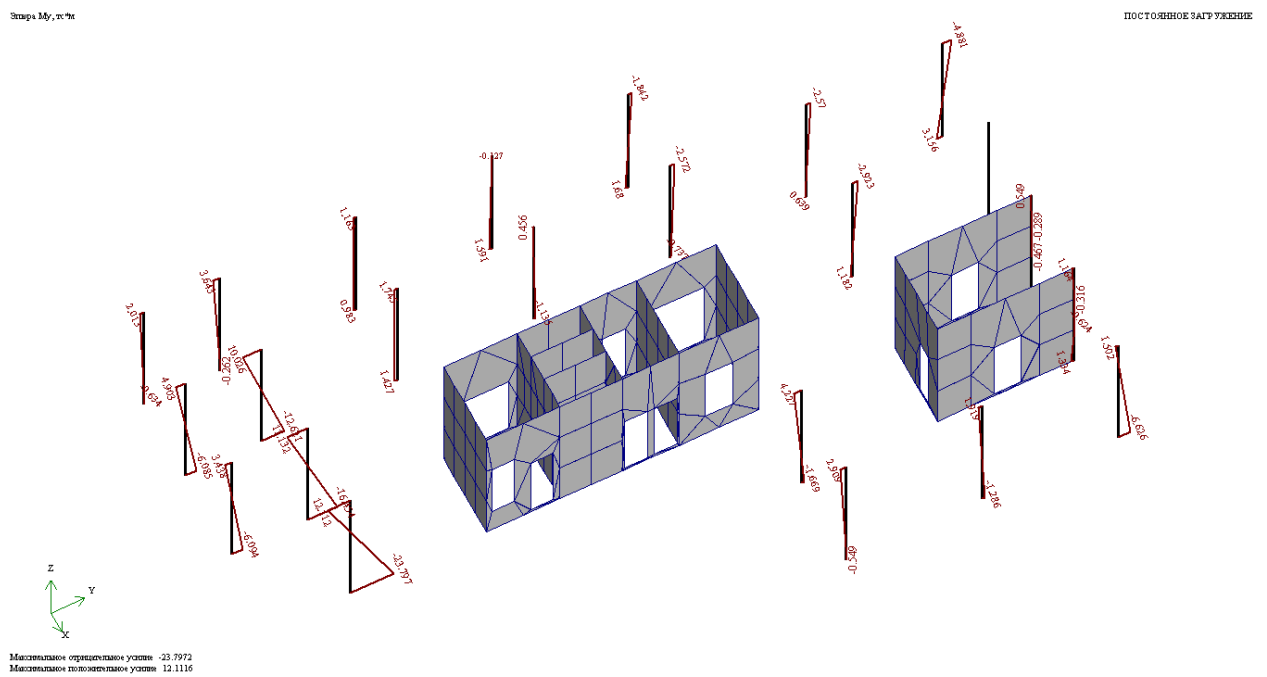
Діаграми зусиль на фрагментованій схемі (3-й поверх)
